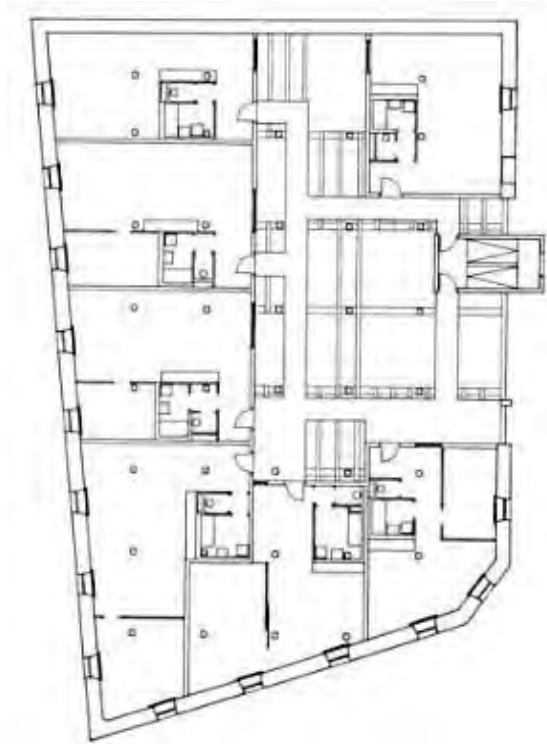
Planta arquitectónica del primer nivel del edificio.
